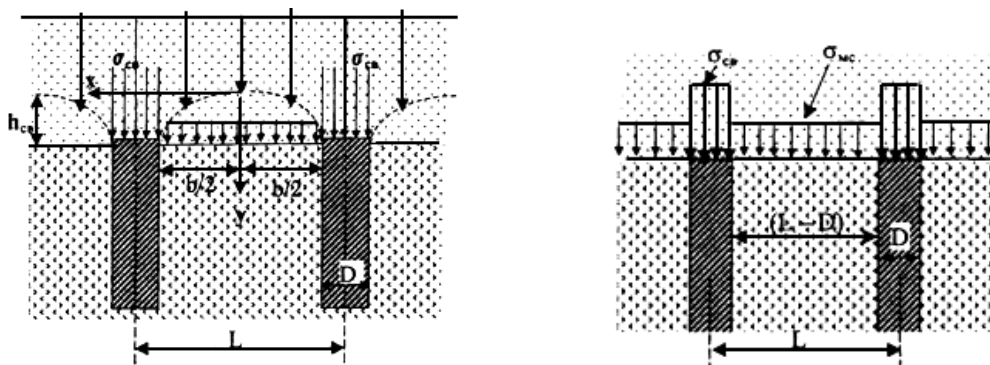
Схема перераспределения внешней нагрузки от веса насыпи при наличии свай
